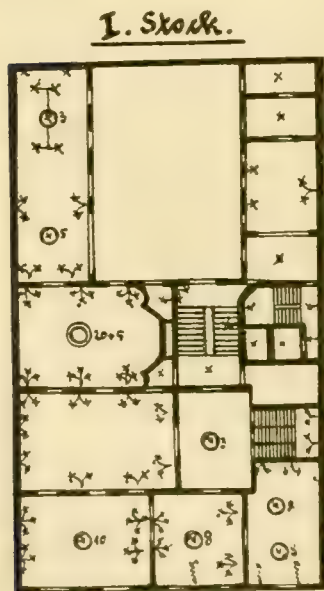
Lampenverteilungsplan für eine Wohnhausinstallation.
